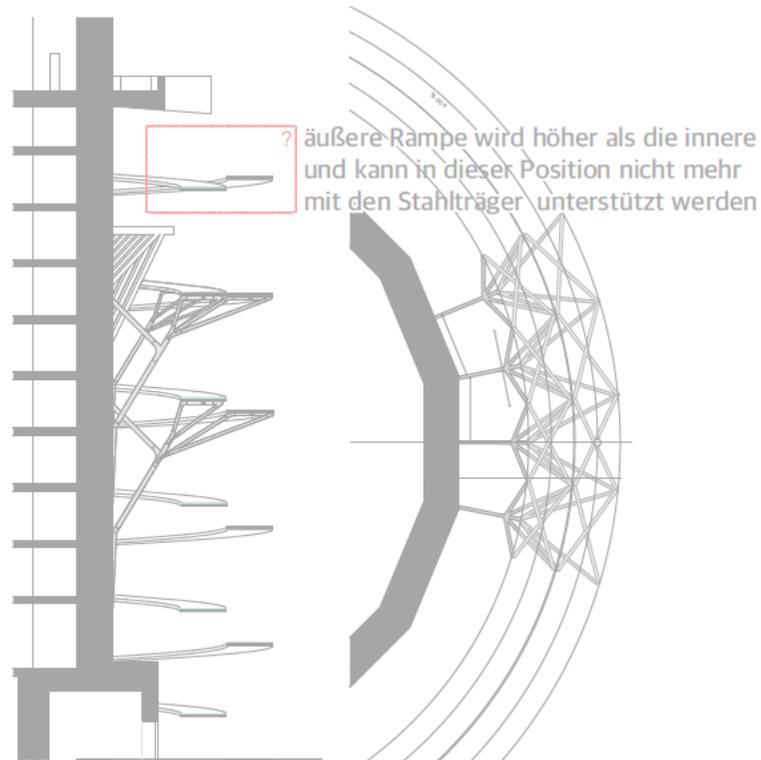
Fassadenschnitt, Konstruktion der Rampe, Skizze 3
